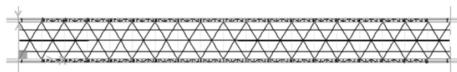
Planta do 2º modo de vibração da estrutura (sem escala) [Fonte própria]
